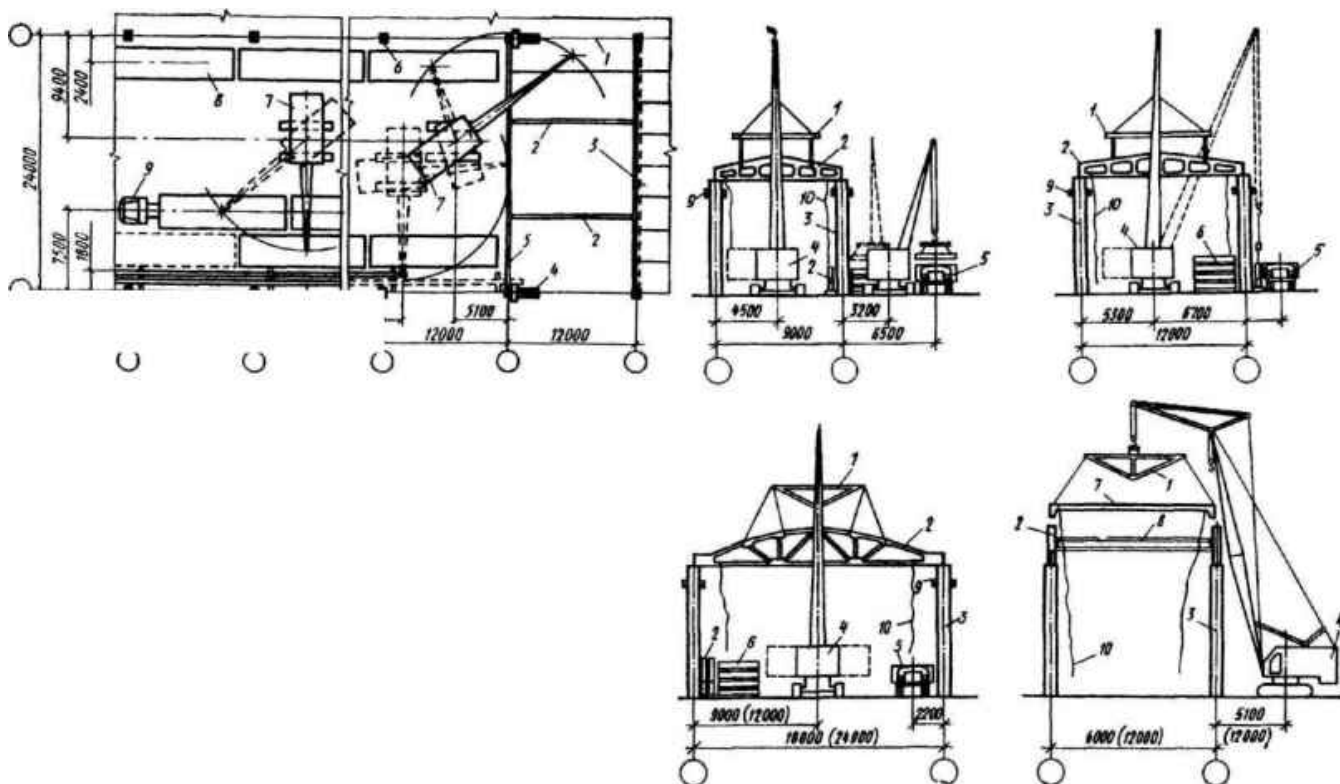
Схема выгрузки, раскладка элементов и монтажа покрытия пролетом 24 м, с шагом колонн и ферм 12 м продольным методом:
